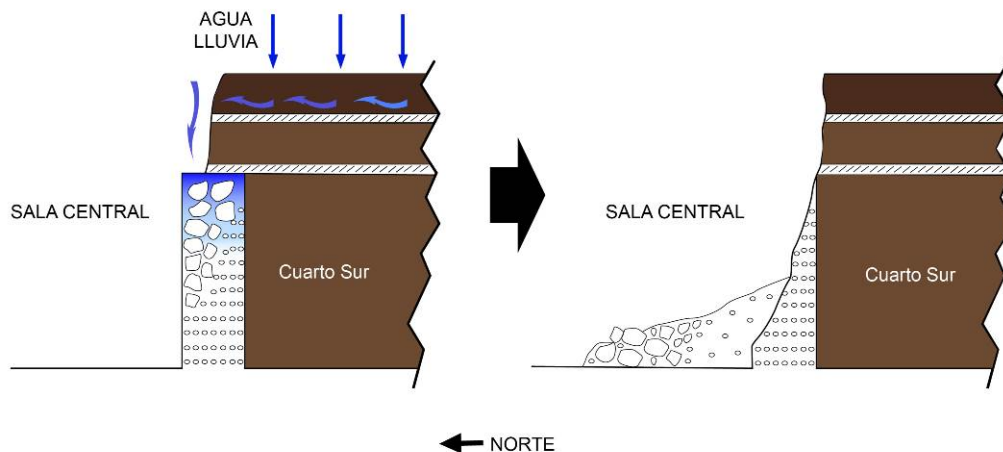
Modelo del proceso de colapso en la pared sur de la Sala Central de B1-1d-III.
